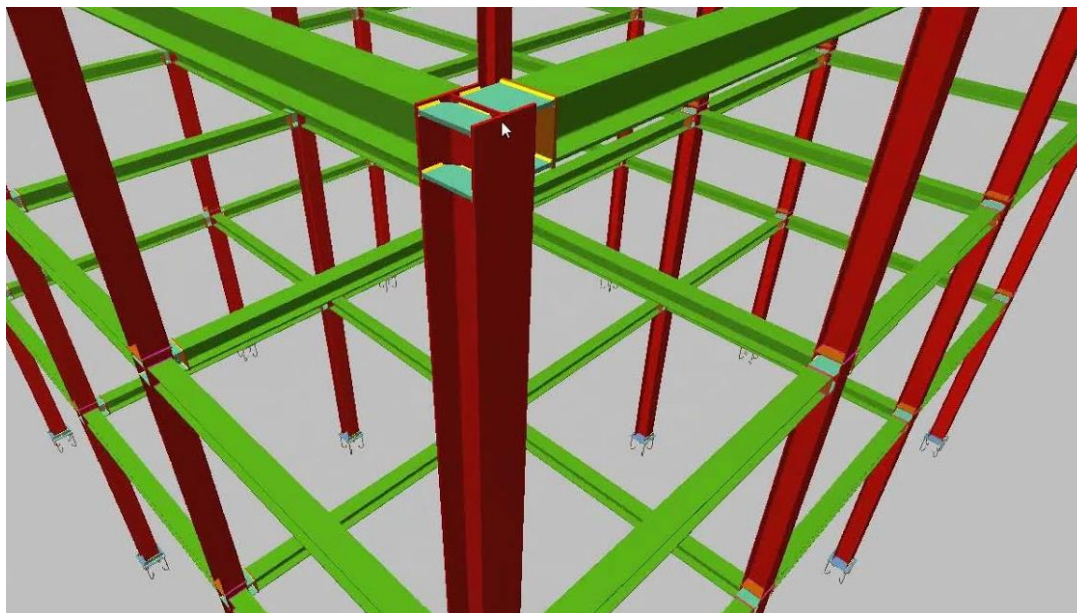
Sistema estructural aplicado al diseño- Dos pisos.
